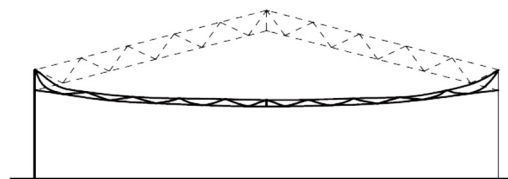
Colapso de pórtico com viga treliçada SIMMS; NEWMAN (2002).
